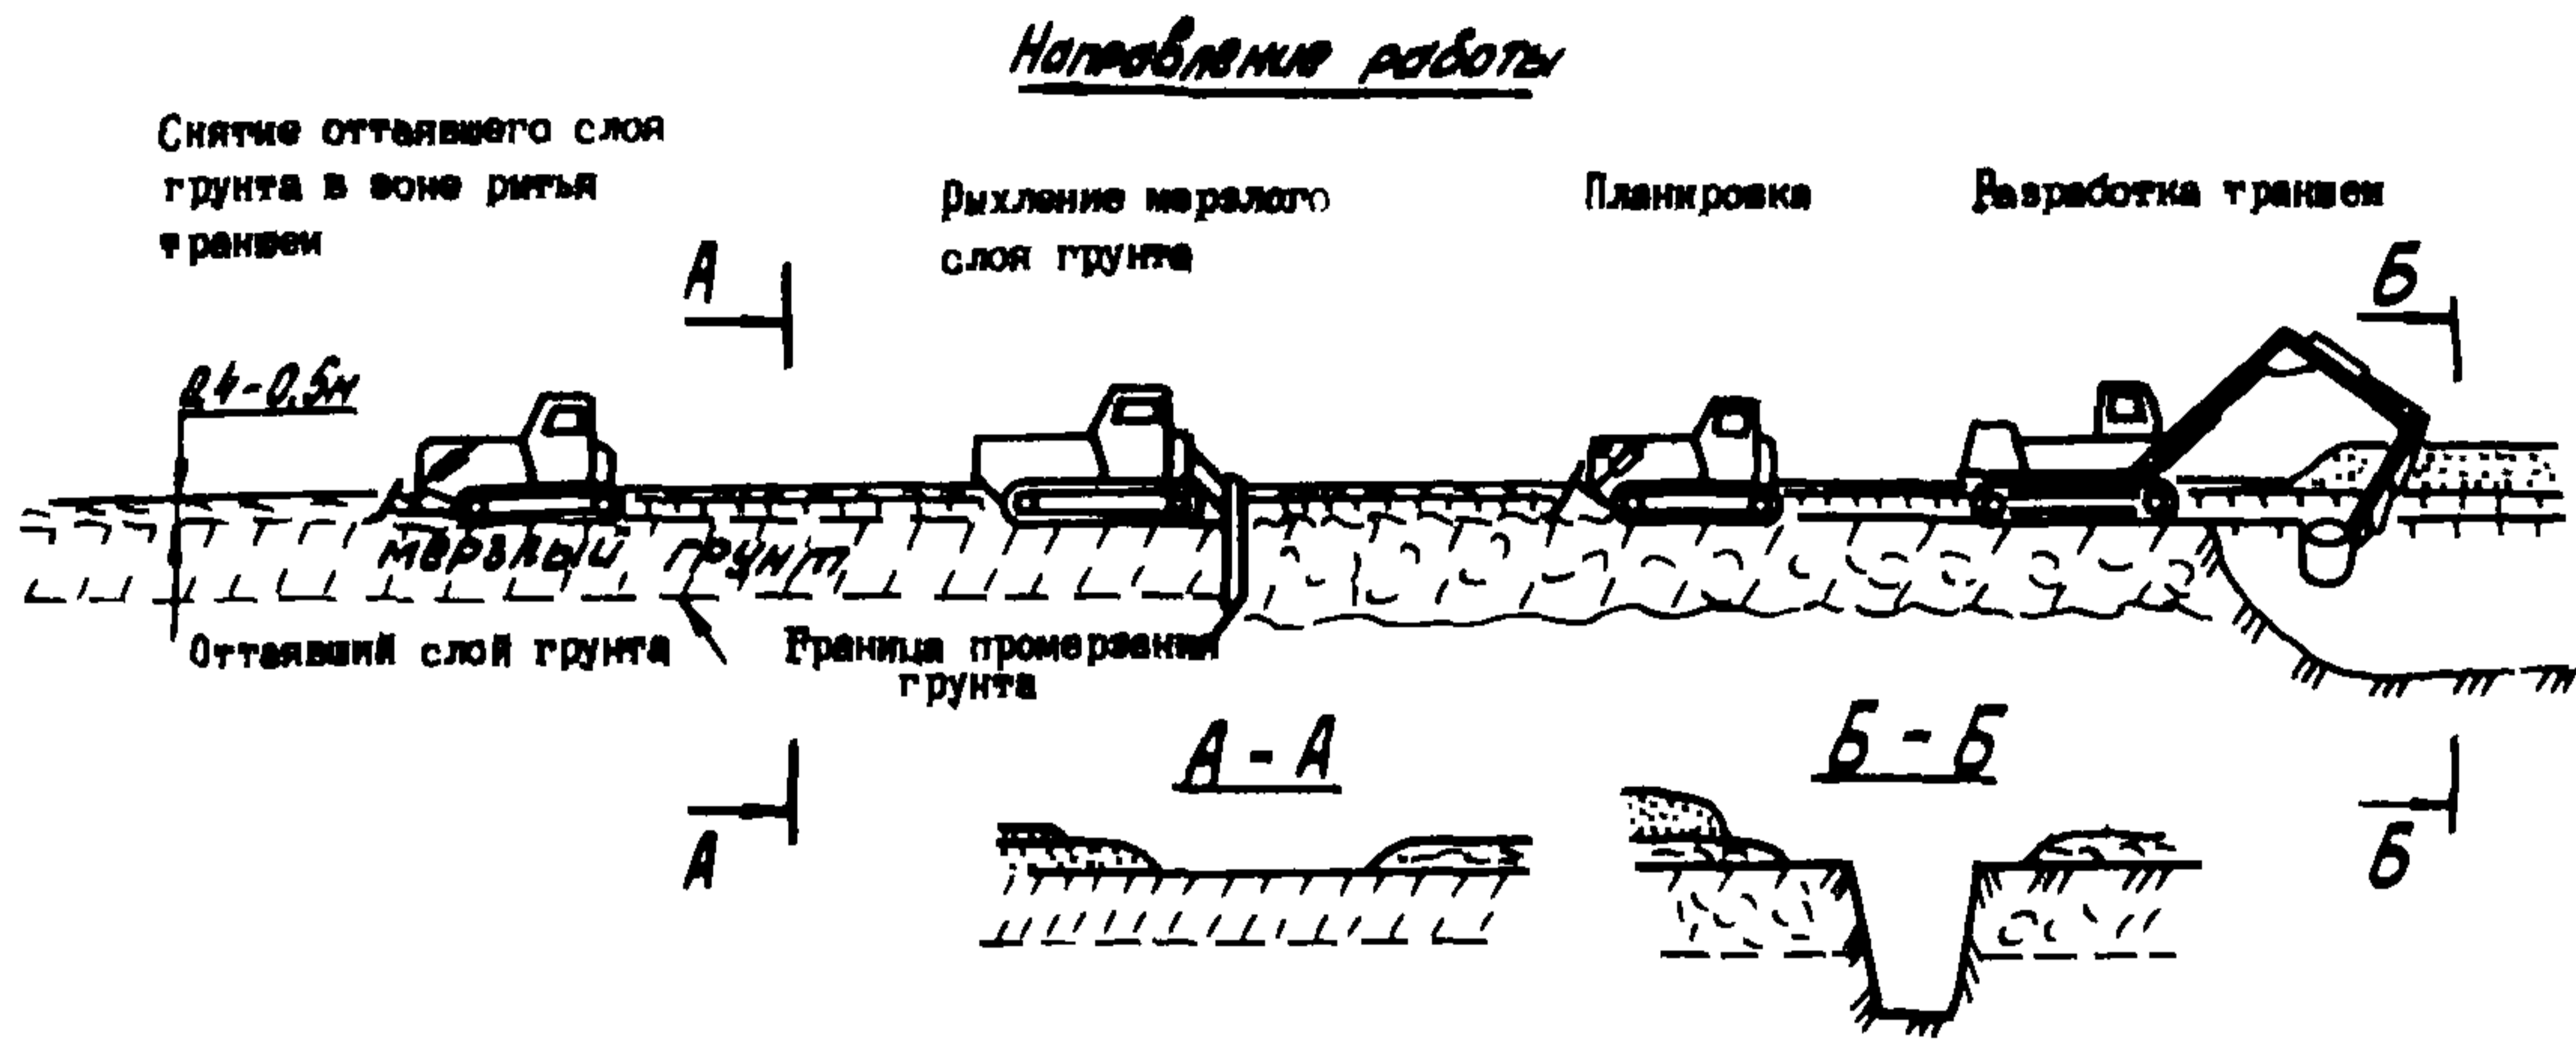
Разработка траншеи в мерзлом грунте при частично оттаявшем верхнем слое
